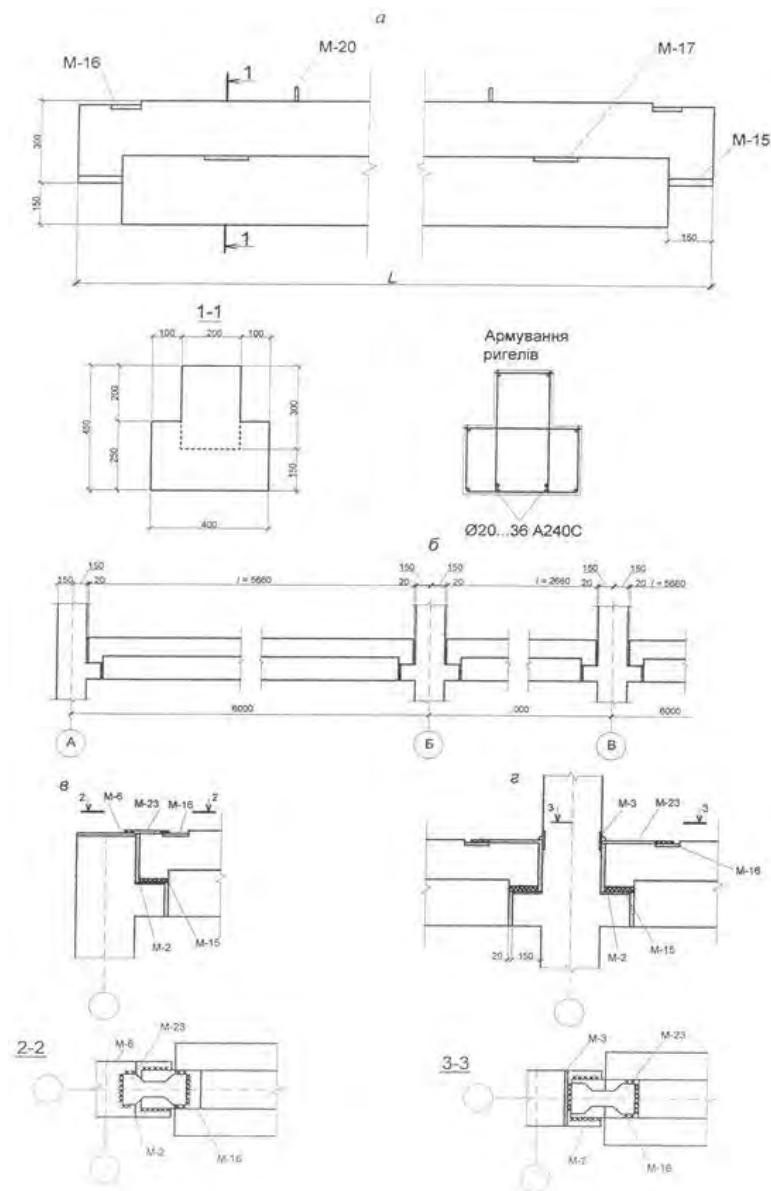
Збірні залізобетонні ригелі: а – розміри, розміщення закладних деталей, армування; б – розташування; в – кріплення ригеля покриття до верху колони; г – кріплення ригелів перекриття до середньої колони
